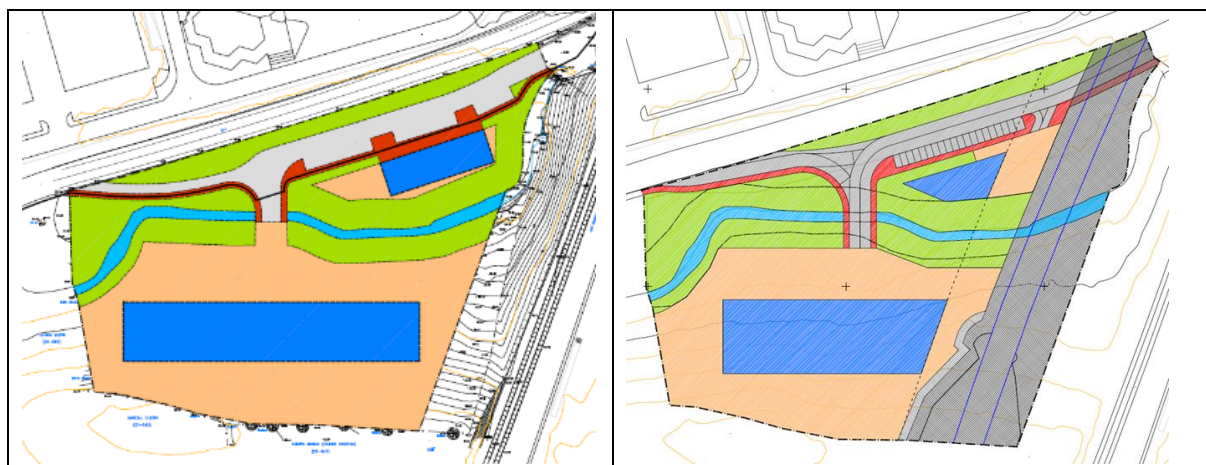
Alternativas de ordenación. Planeamiento vigente (izquierda) y propuesta del PEOU (derecha).
